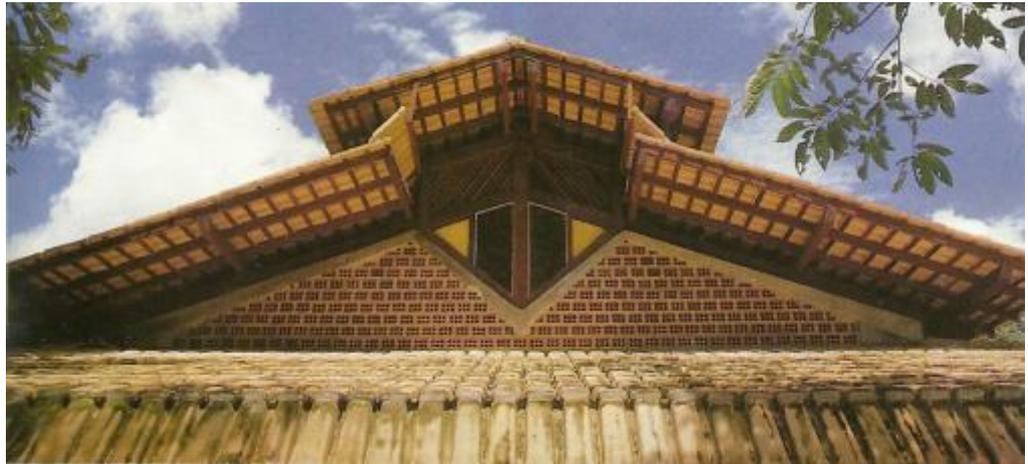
Telhado com lanternim e beirais no Retiro Tagaste. Fonte: Revista Projeto nº102.
